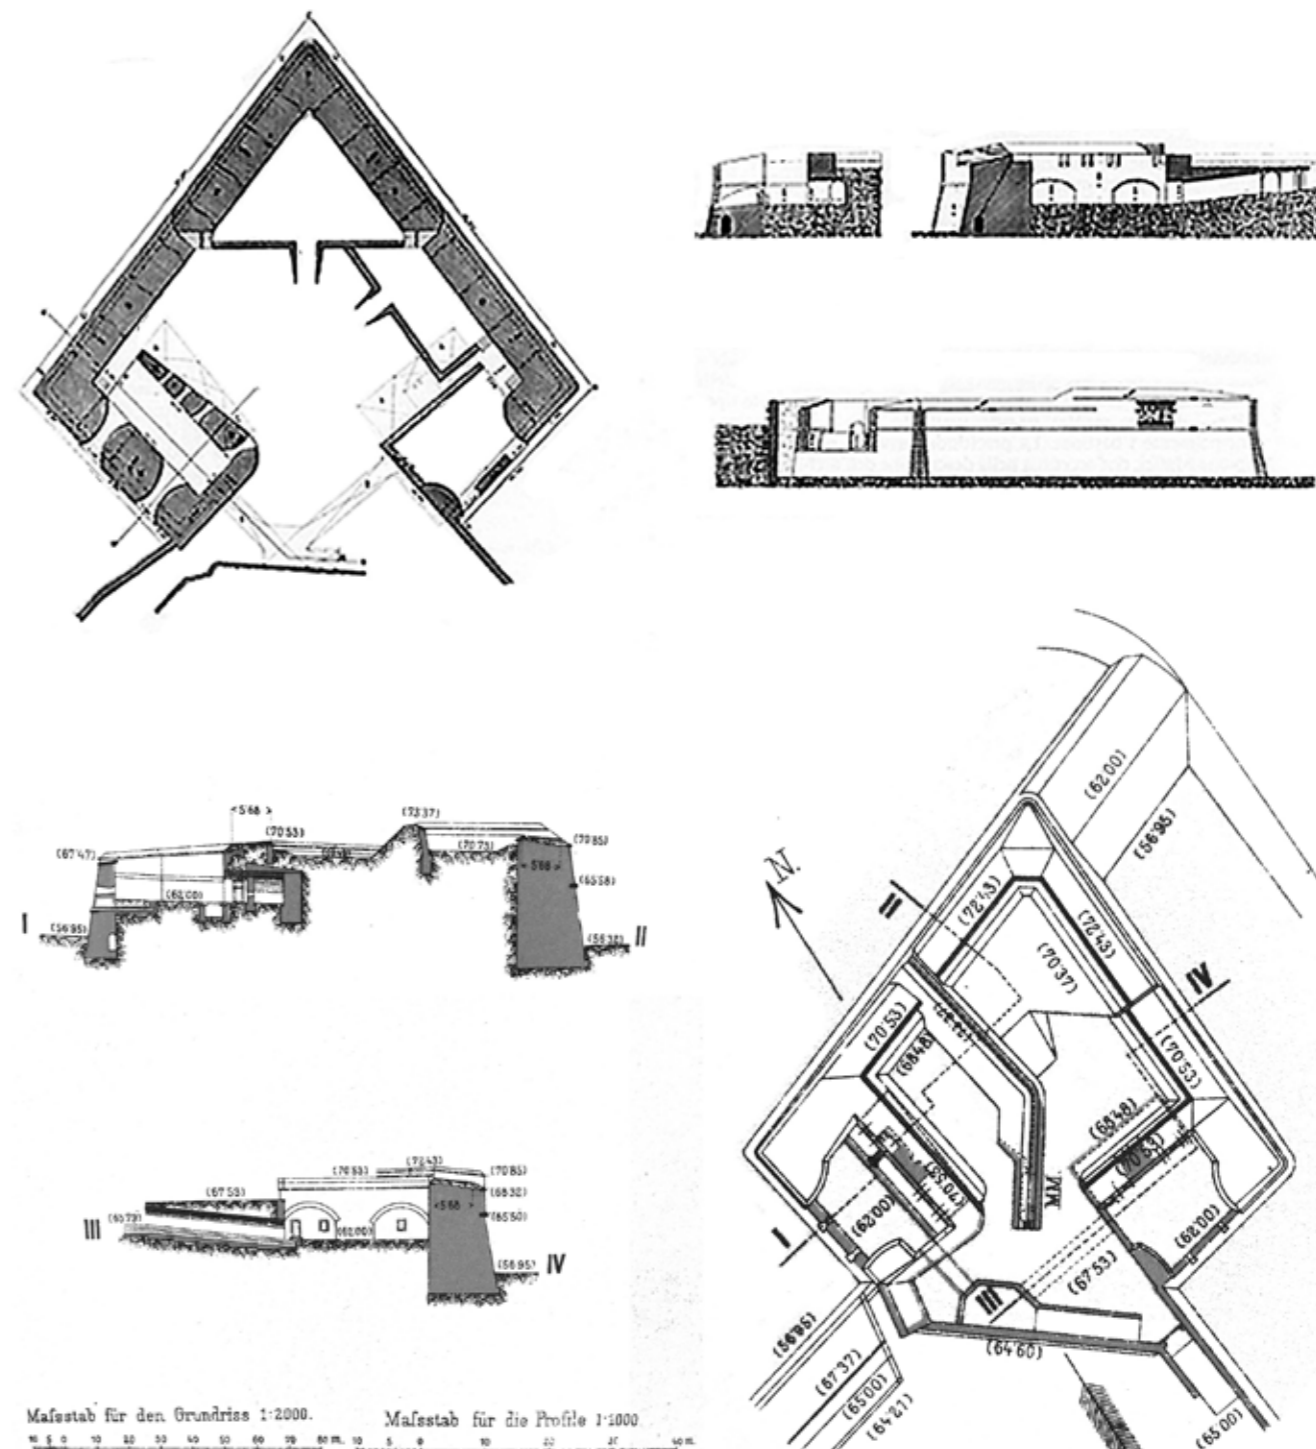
(Sopra) Bastione di Spagna nell'assetto originario, prima dell'intervento austriaco, pianta, sezioni e prospetto (Ronzani - Luciolli). (sotto) Nell'Ottocento il bastione è stato riordinato con la disposizione sul piazzale di una traversa casamattata. Capolavoro della fortificazione sanmicheliana, è uno degli ultimi bastioni edificati dal maestro veronese, superstiti alle demolizioni napoleoniche.
